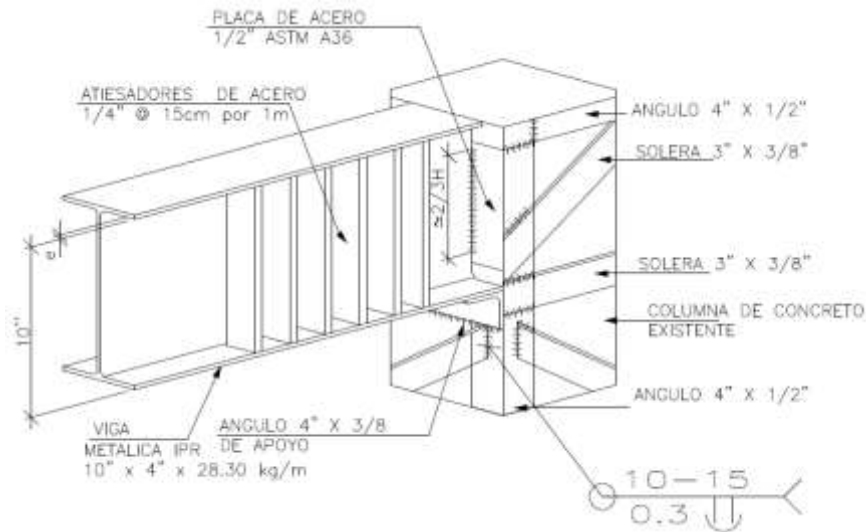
Detalle de conexión de viga IR para marcos contraventeados, Proyecto estructural.
